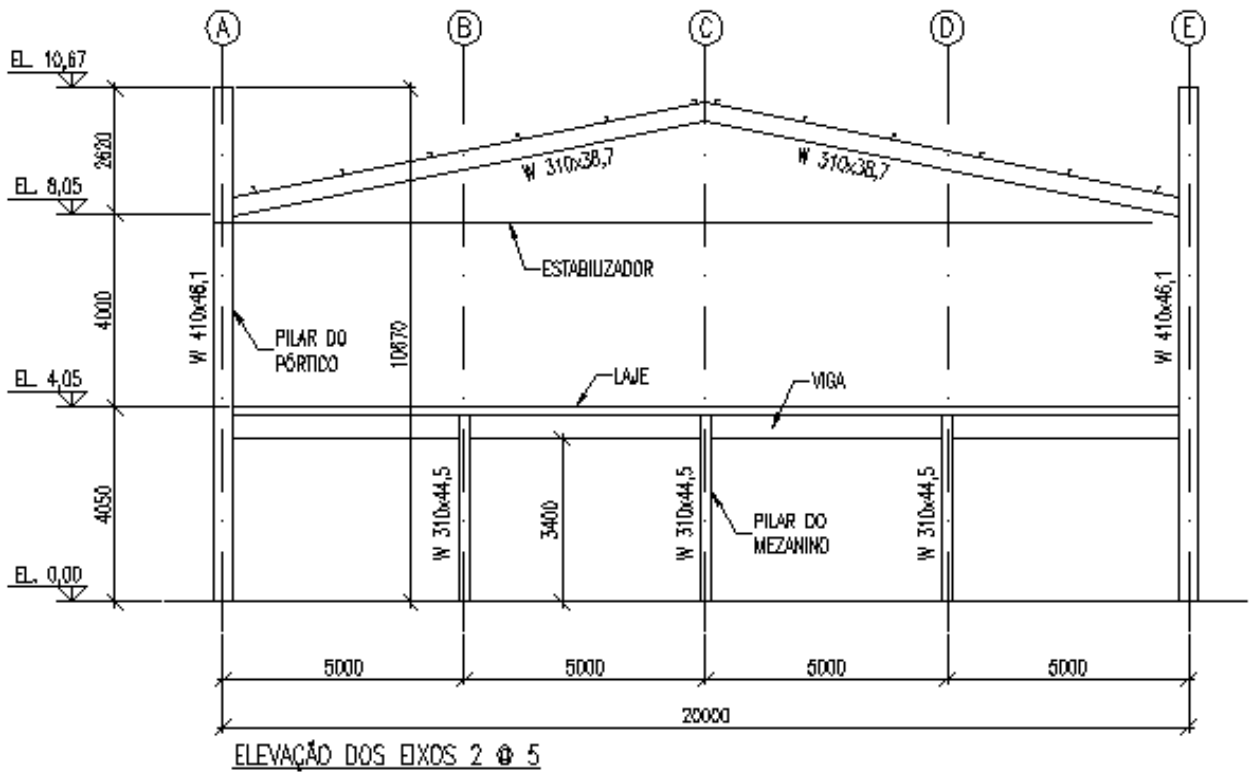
Elevações transversais da edificação para estrutura metálica.
